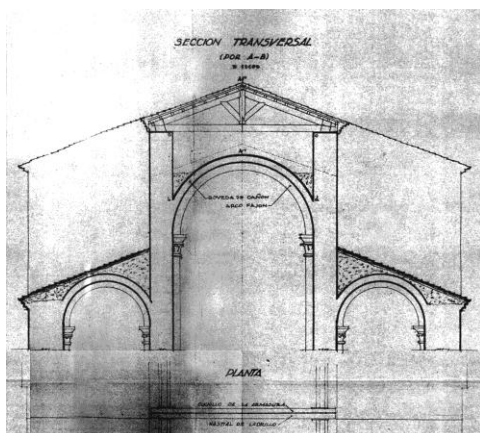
Seo de Urgel. Catedral de Santa María AAFV. Planta y Sección Transversal Naves
